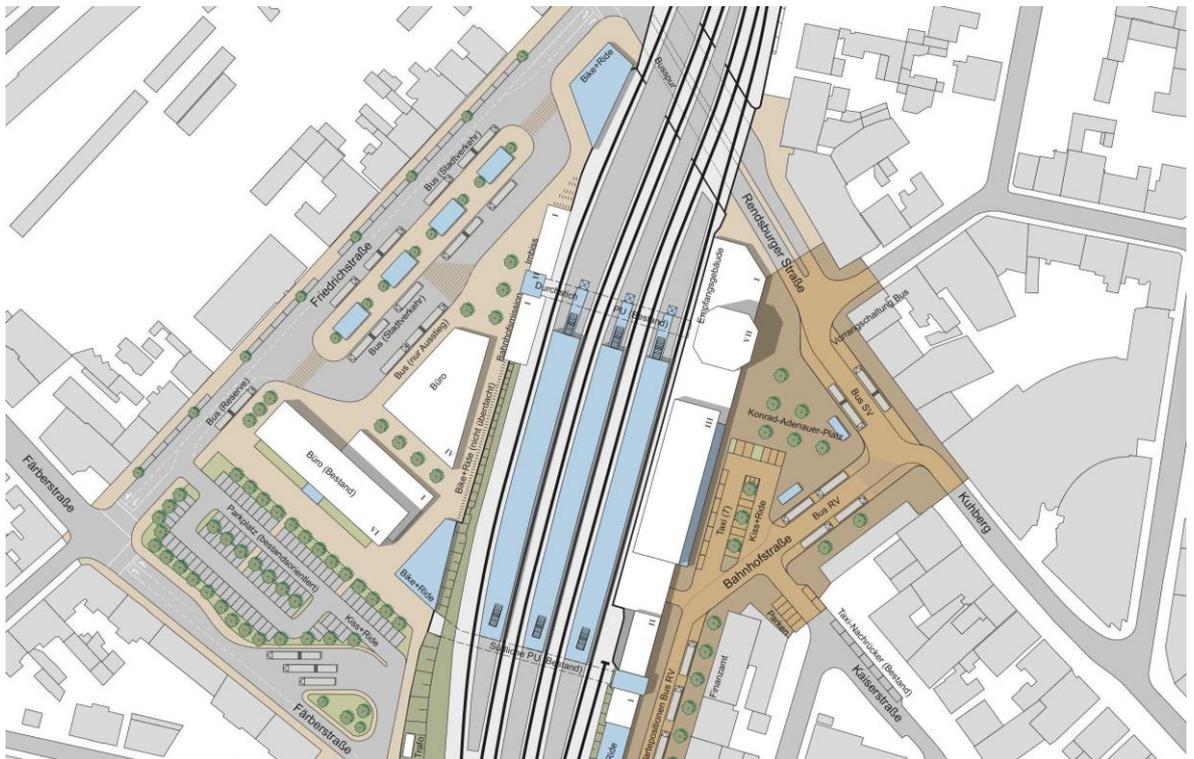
Ausschnitt des Lageplans I A – Erhalt Postgebäude / Erhalt Parkplatz
